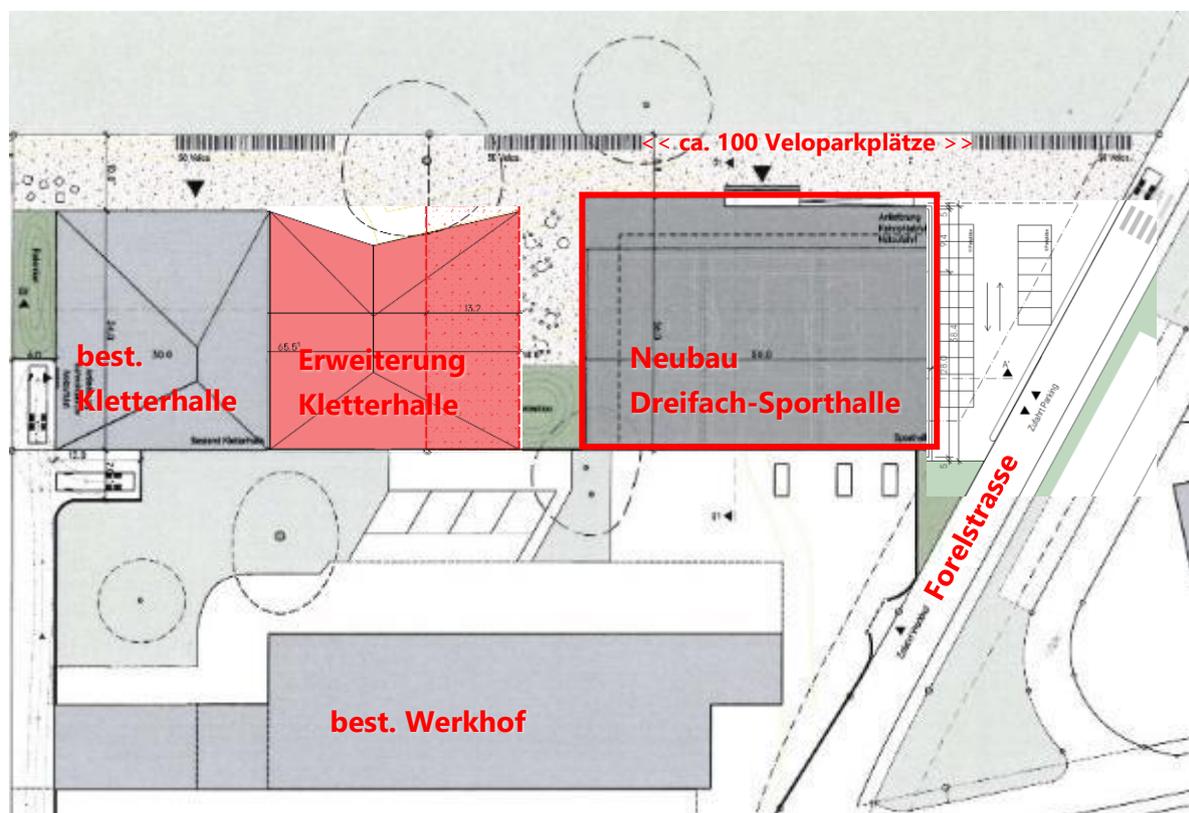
Situationsplan mit Werkhof, Kletterhalle und neuer Sporthalle
